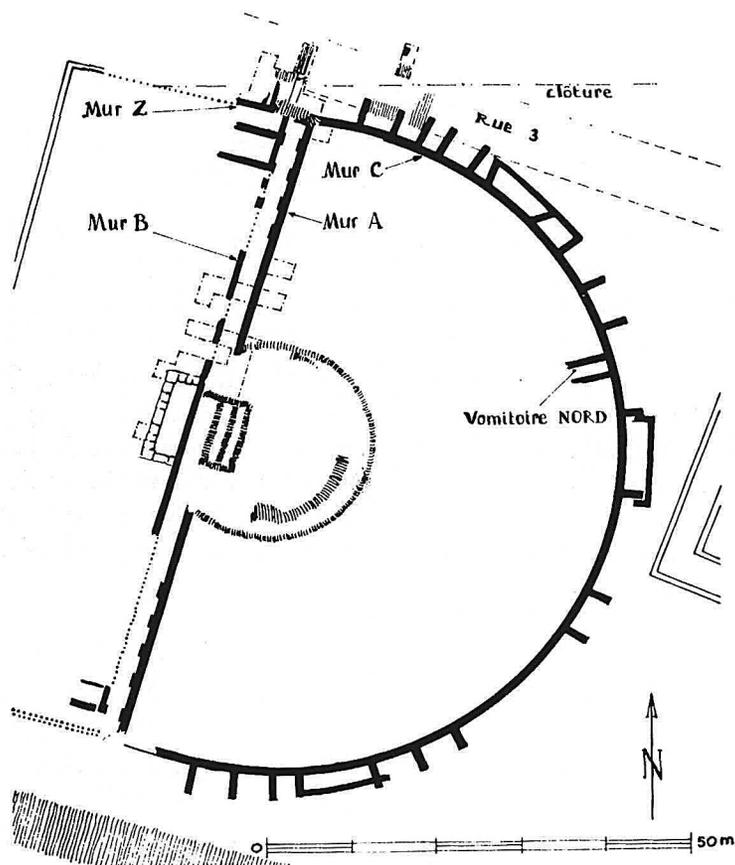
Angle Nord-Ouest du Théâtre et mur de façade, plan de situation des fouilles de 1984-1986.
